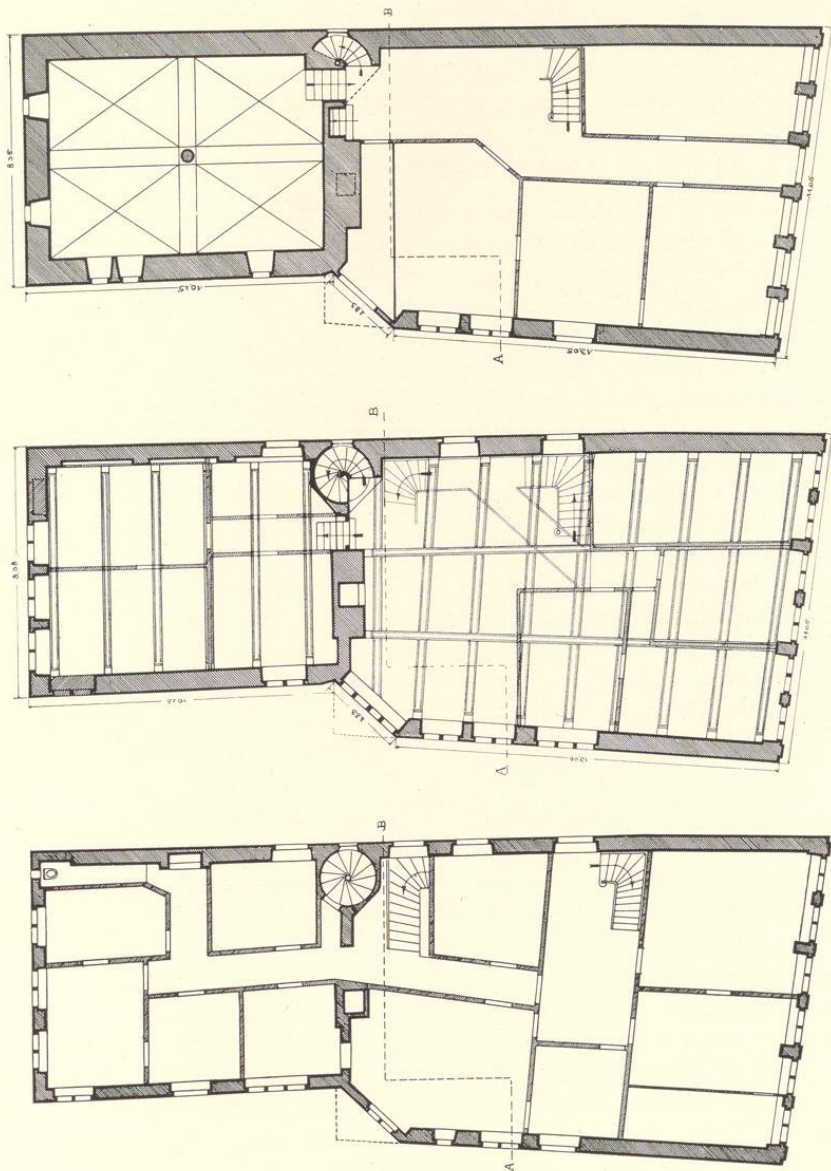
792. Grundriß des Erdgeschosses, Zwischengeschosses und Obergeschosses des Hauses Ägidiistraße 62
